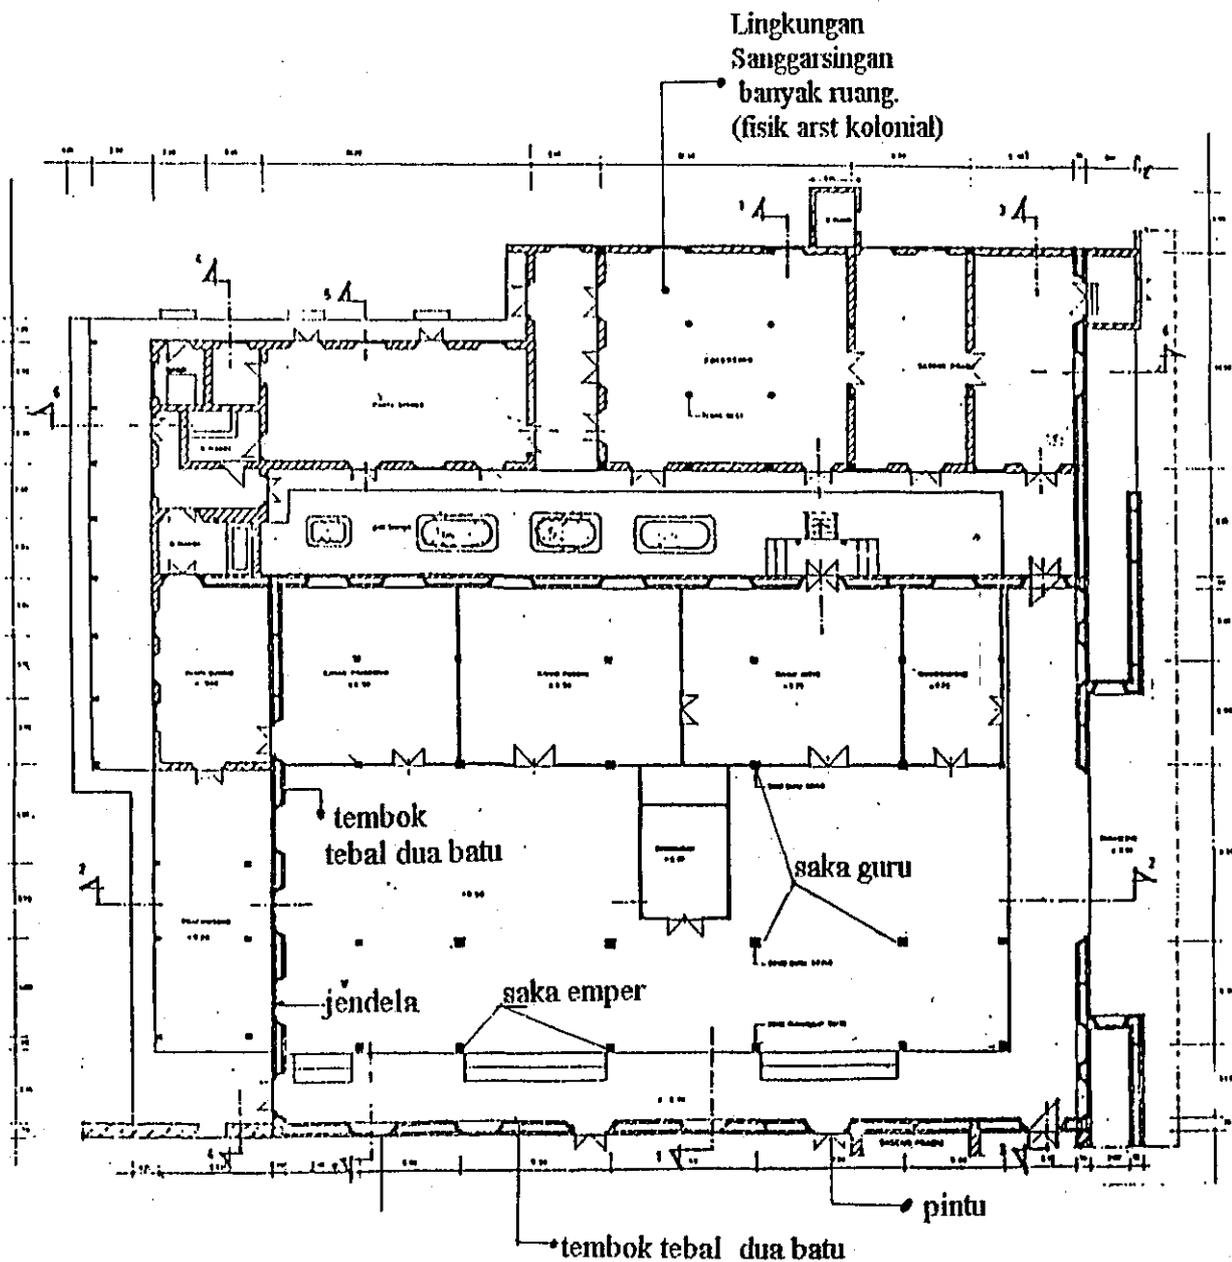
Bangunan Pendapa Agung Sasono Sewoko, Karaton Surakarta dibangun pada masa pemerintahan Paku Buwono III, (1748-1788). Terdapat kolom dari besi tuang, atap seng, merupakan elemen dari arsitektur kolonial Belanda.
